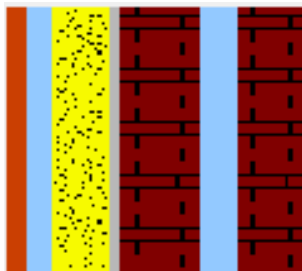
HULC. Estado reformado. Fachada cotegrán.
